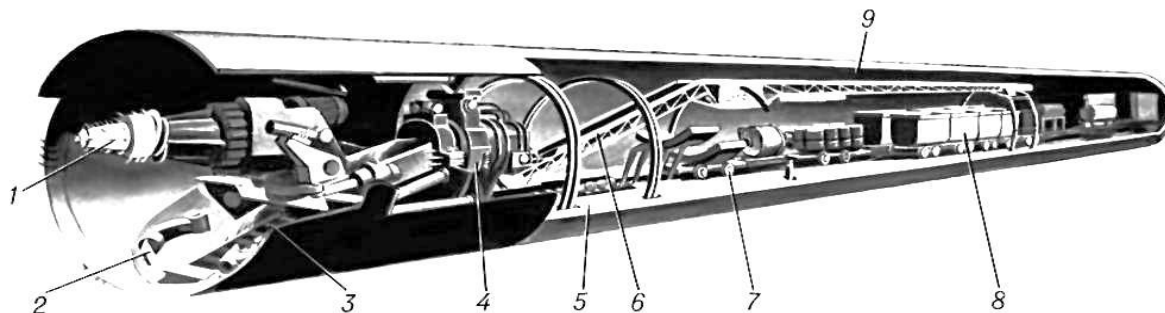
Строительство подземной выработки щитовым комплексом [Tunneling with shield TBM]
